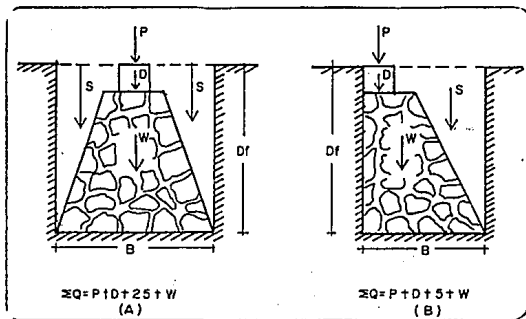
FUERZAS VERTICALES QUE ACTUAN EN ZAPATAS CORRIDAS
